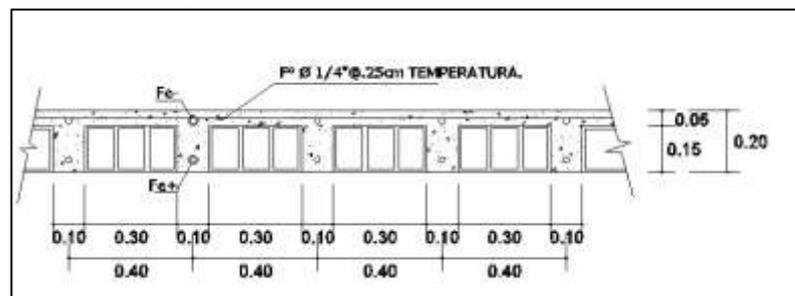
Detalle de losa aligerada. FUENTE: Elaboración propia.
